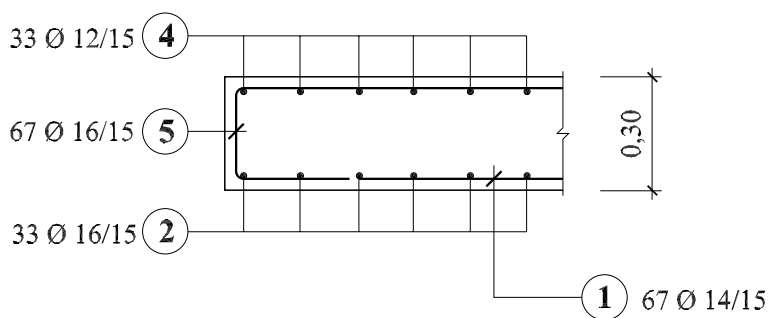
Bewehrung und Abmessungen der Platte (Abmessungen in m).
